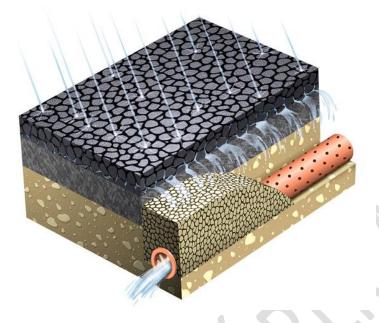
Corte esquemático de asfalto drenante. Disponível em: < https://www.inovacivil.com.br/asfalto-permeavel/ >
